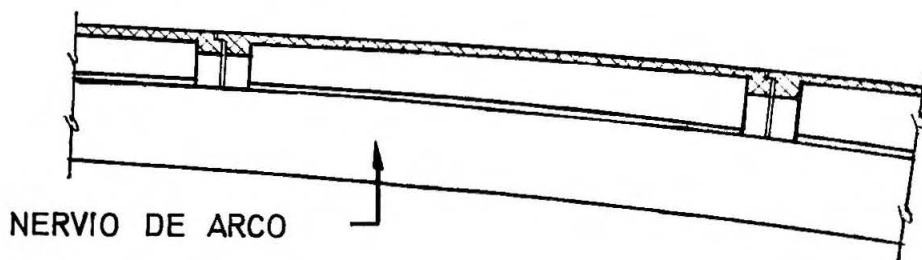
SECCION LONGITUDINAL DE UN CASCO.
